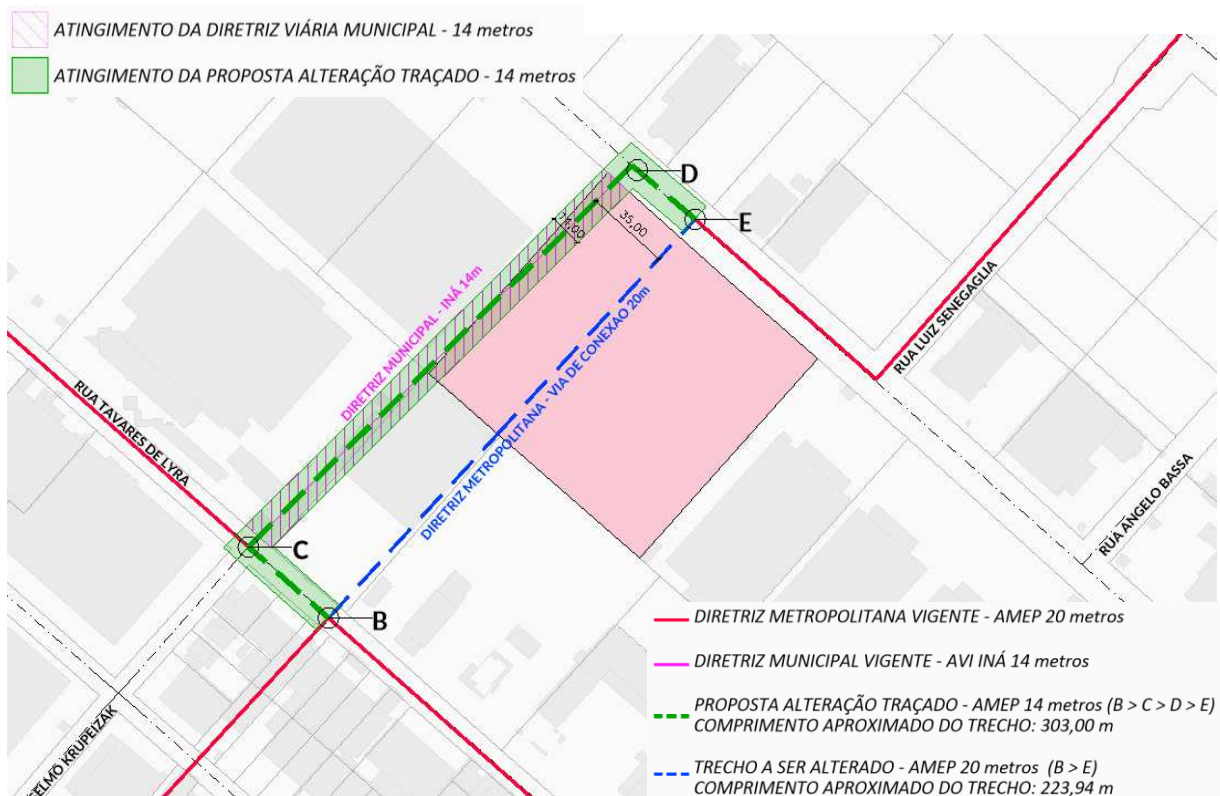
Alteração de Traçado Proposta 1 - Diretriz Metropolitana (14m)
